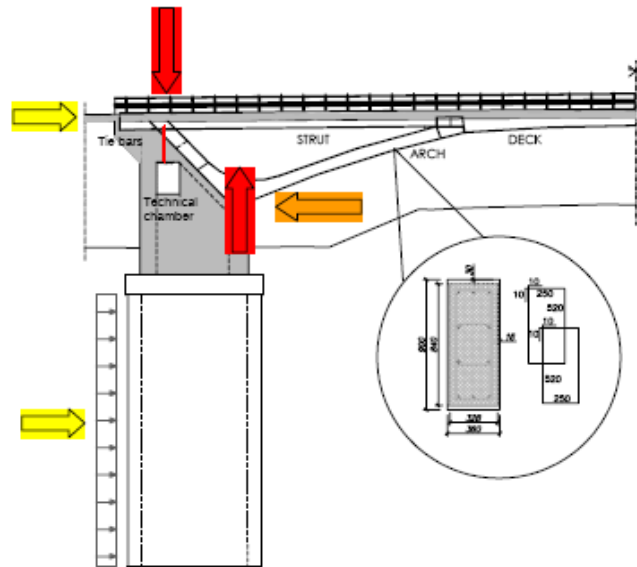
Ponte sull'autostrada Brennero - Sezioni trasversali e particolari degli archi laterali e dell'impalcato (Zordan, 2005)
